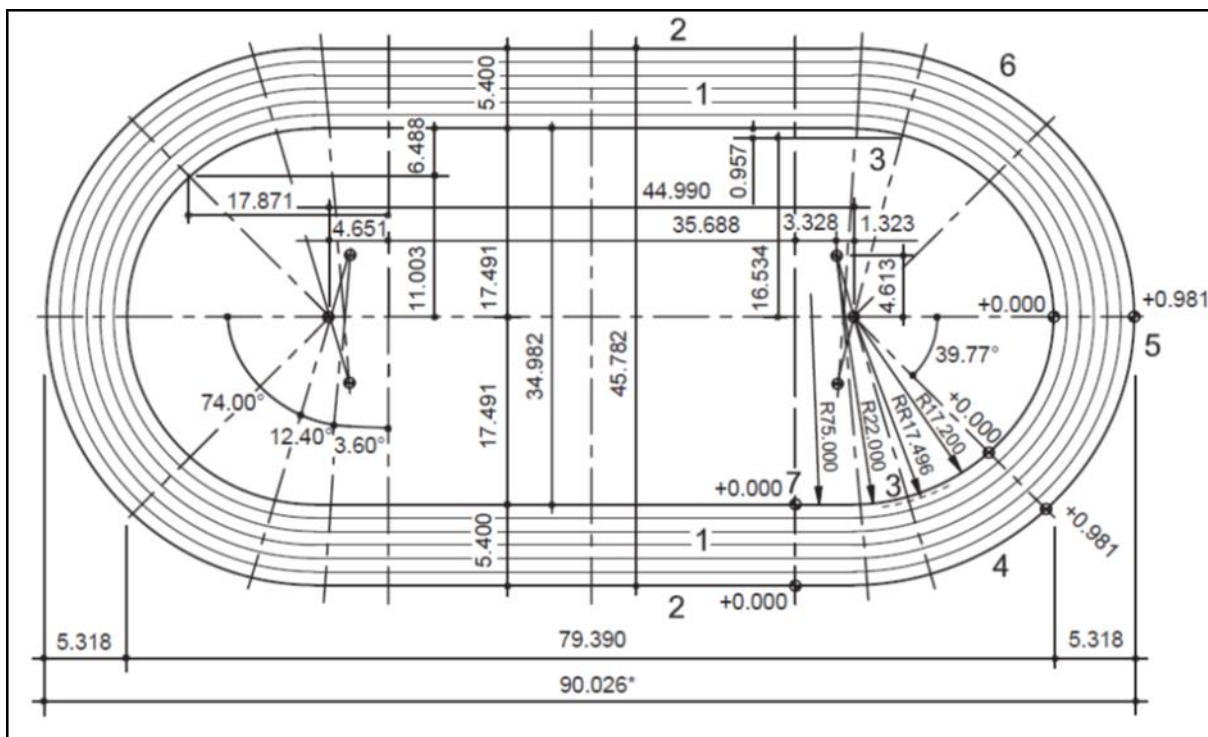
Plan d'implantation de la piste couverte de 200m standard (dimensions en m)
